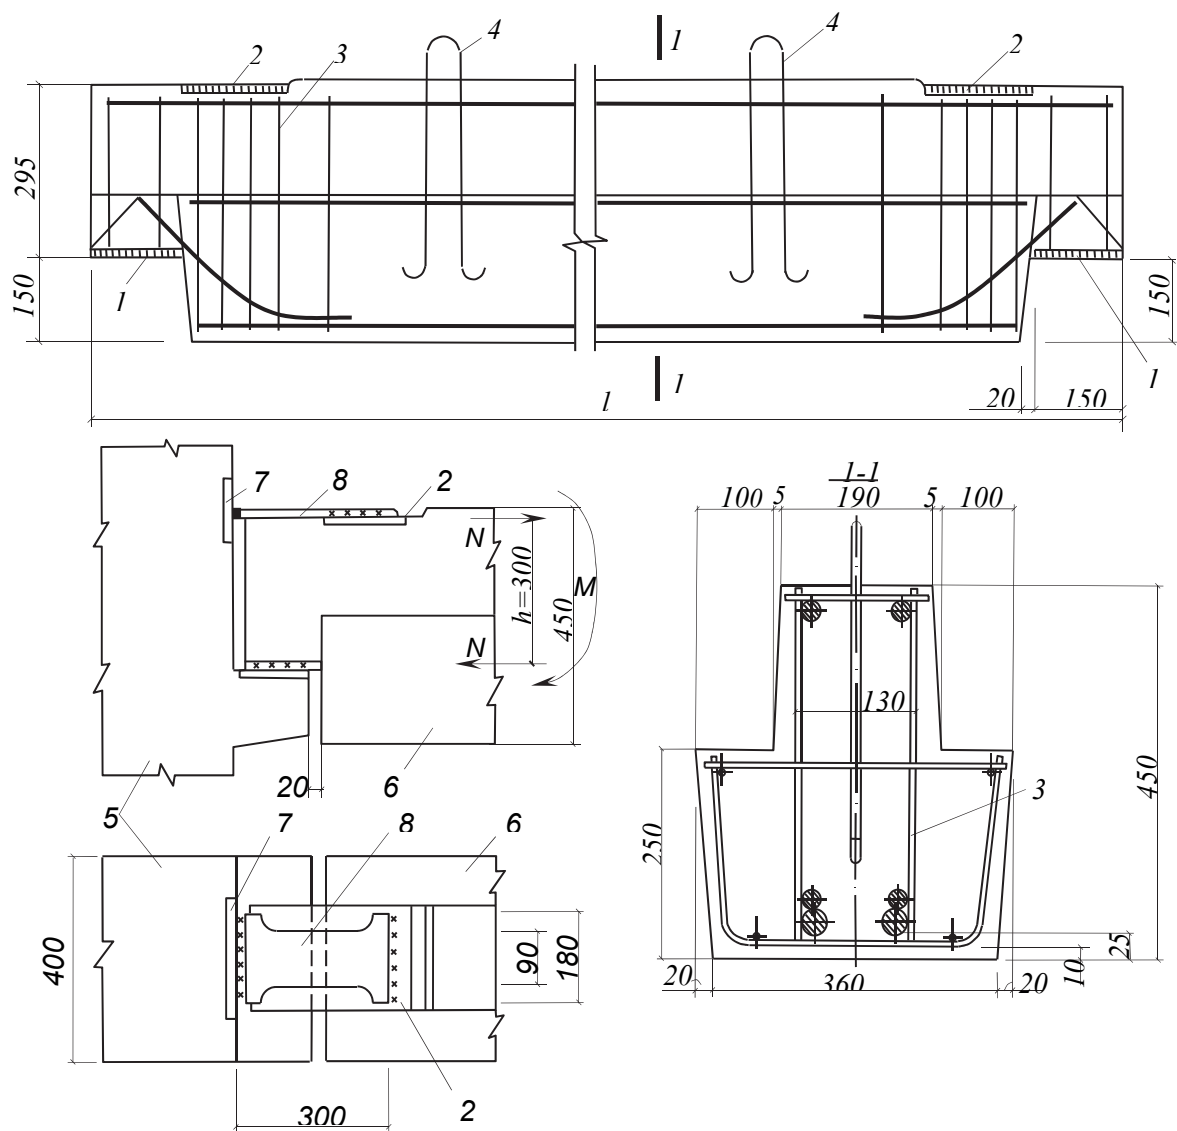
Конструкция ригеля и узла опирания ригеля на колонну в связевом каркасе:
